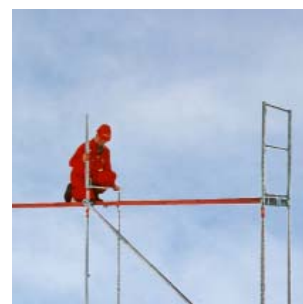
Zabezpieczenie pomostów przed wyparciem – konstrukcja ramy systemu plettac SL70
